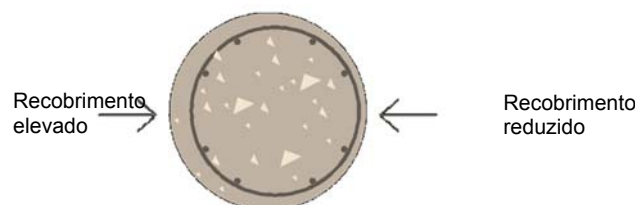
Corte transversal de um pilar genérico evidenciando a autocorrelação espacial entre faces opostas da secção devida à rigidez da caixa de armaduras.
